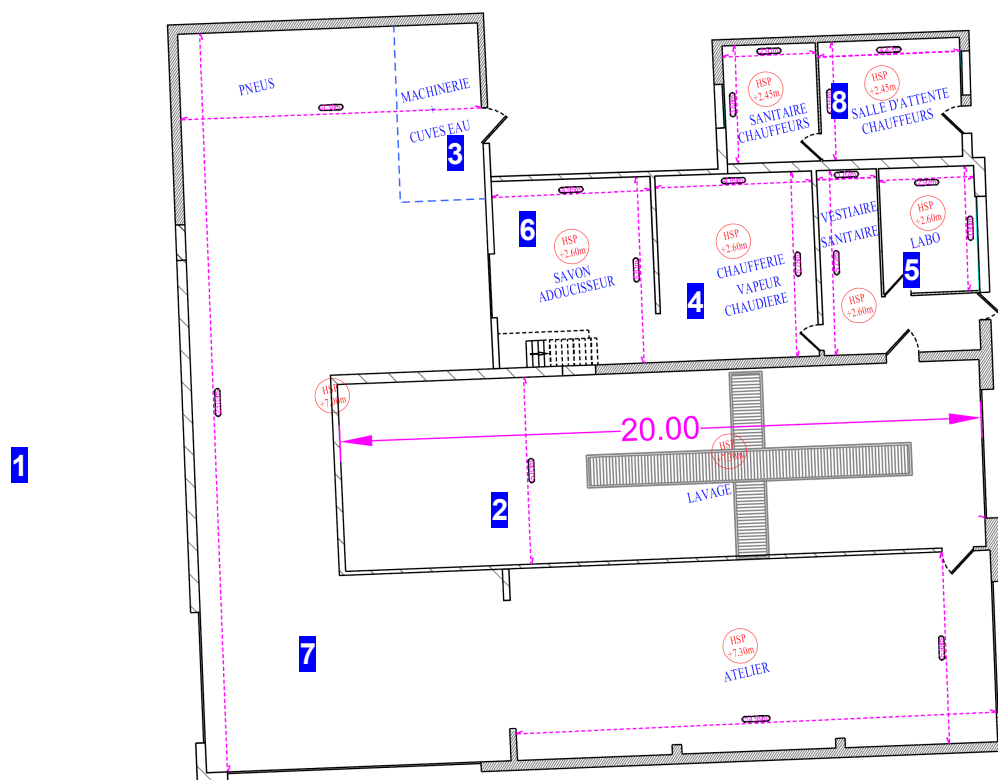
PLAN DU BÂTIMENT TECHNIQUE
